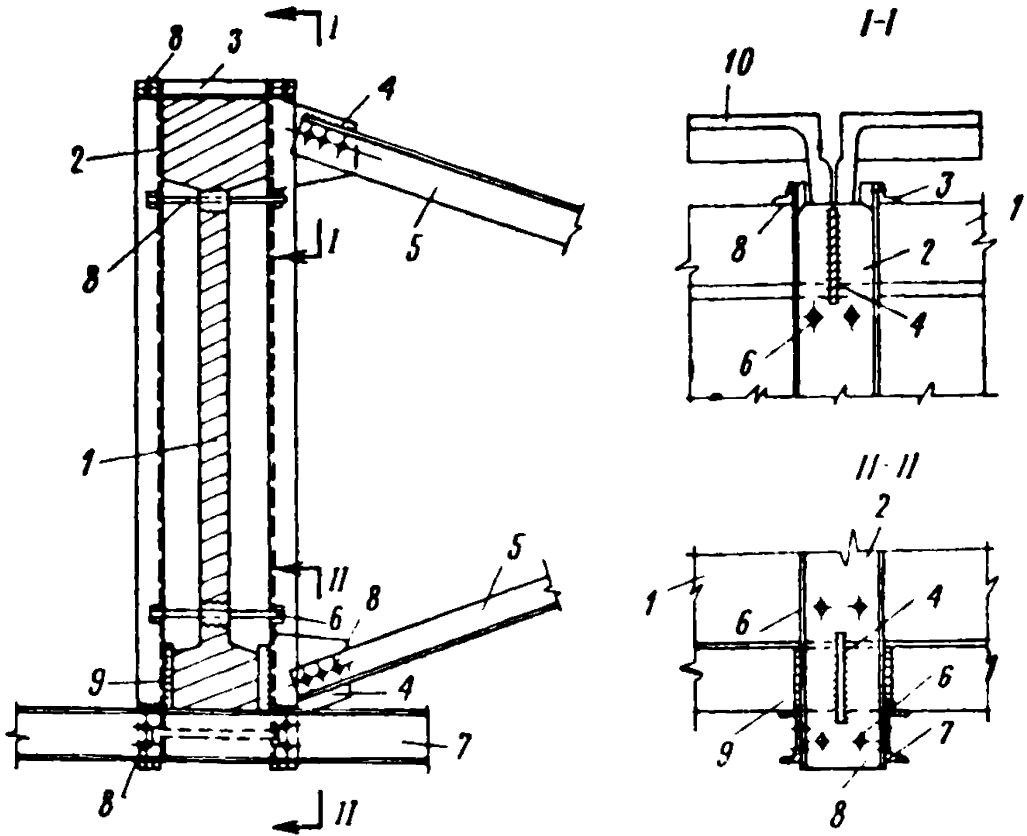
Схема устройства продольных связей между железобетонными фермами (балками)
